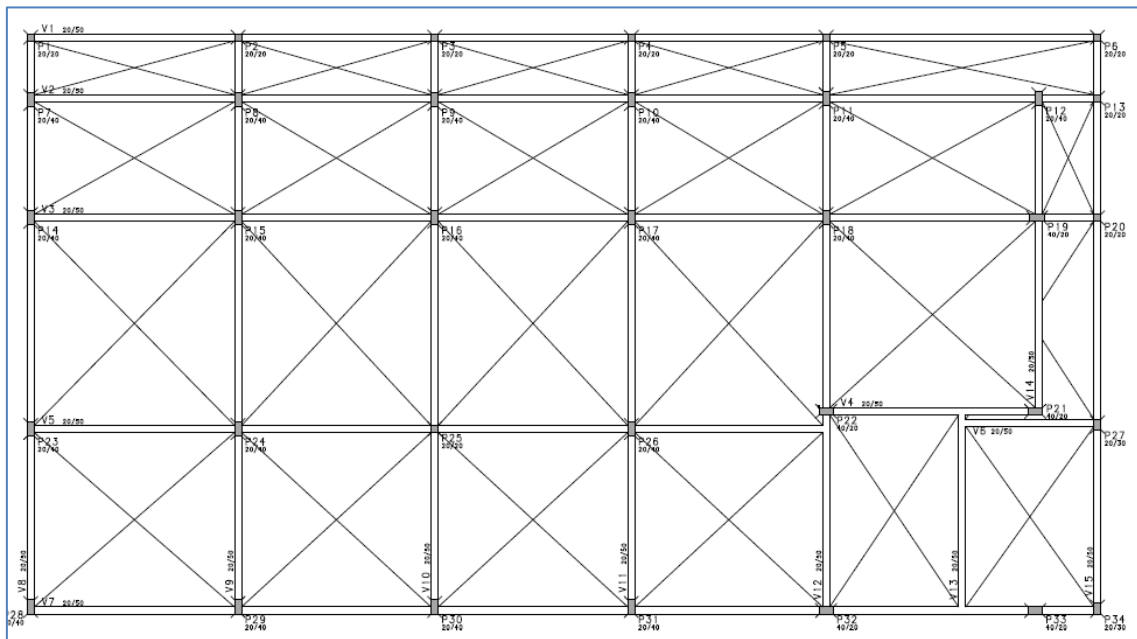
Planta de fôrma: fundação, concreto armado (CAD/TQS)
